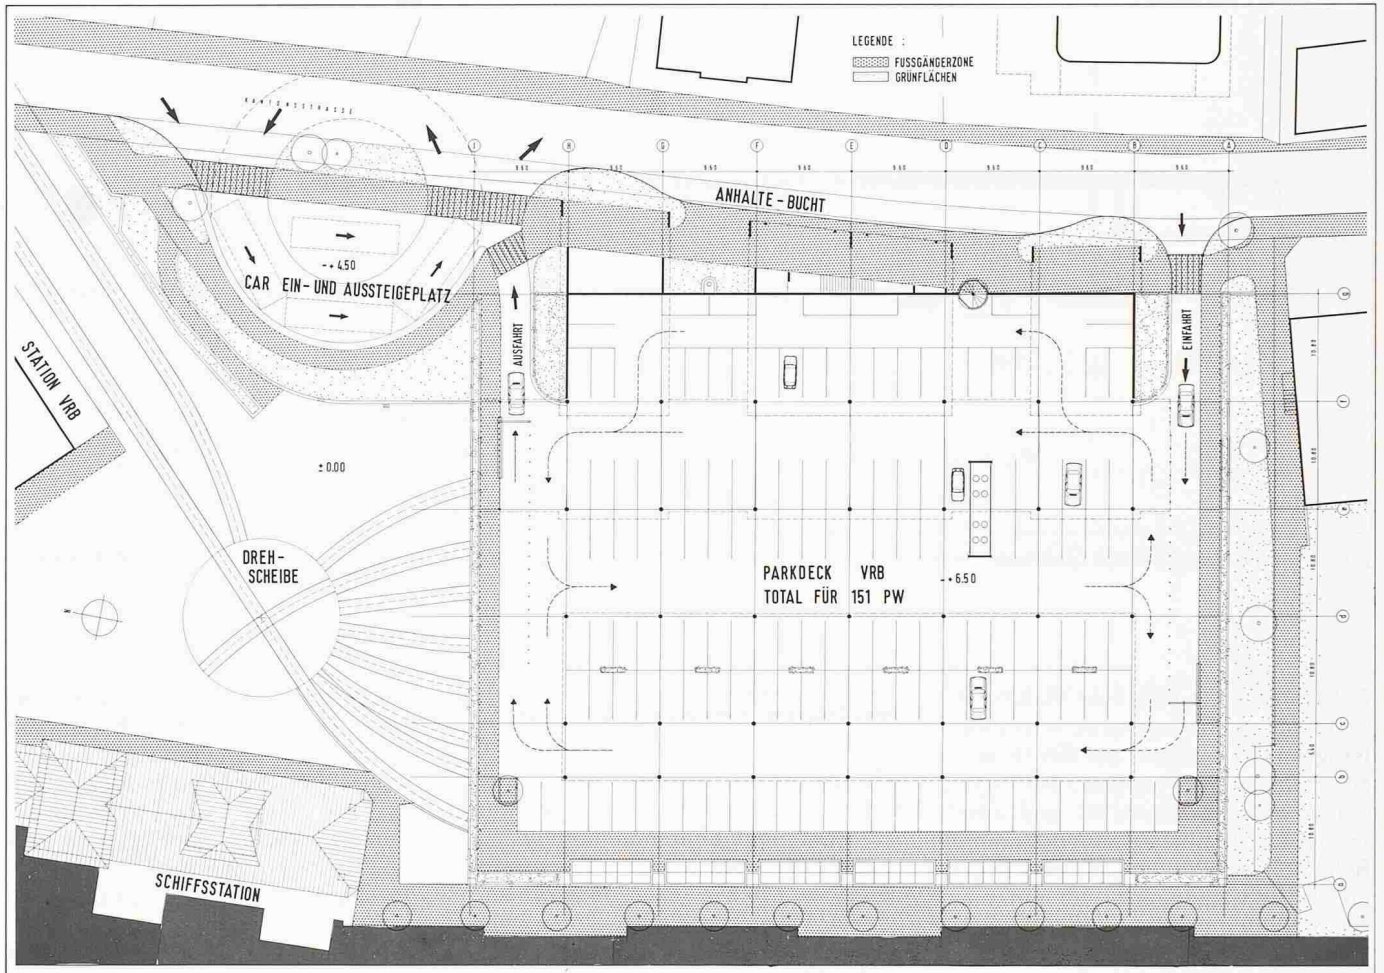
Verkehrskonzept. Grundriss 1. Oberdeck mit Carwendeplatz, Zufahrt zu Parkdeck, Fussgängerzonen
